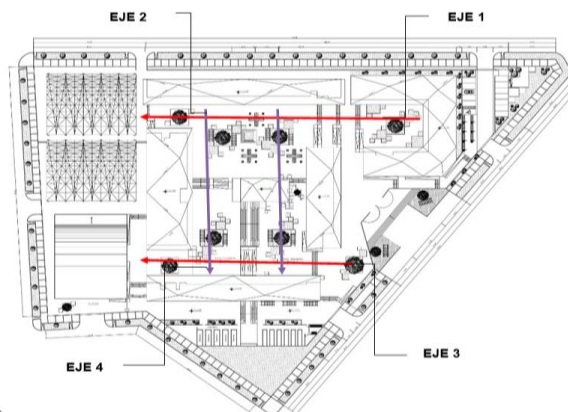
eje arquitectónico del proyecto, Fuente: Elaboración propia
